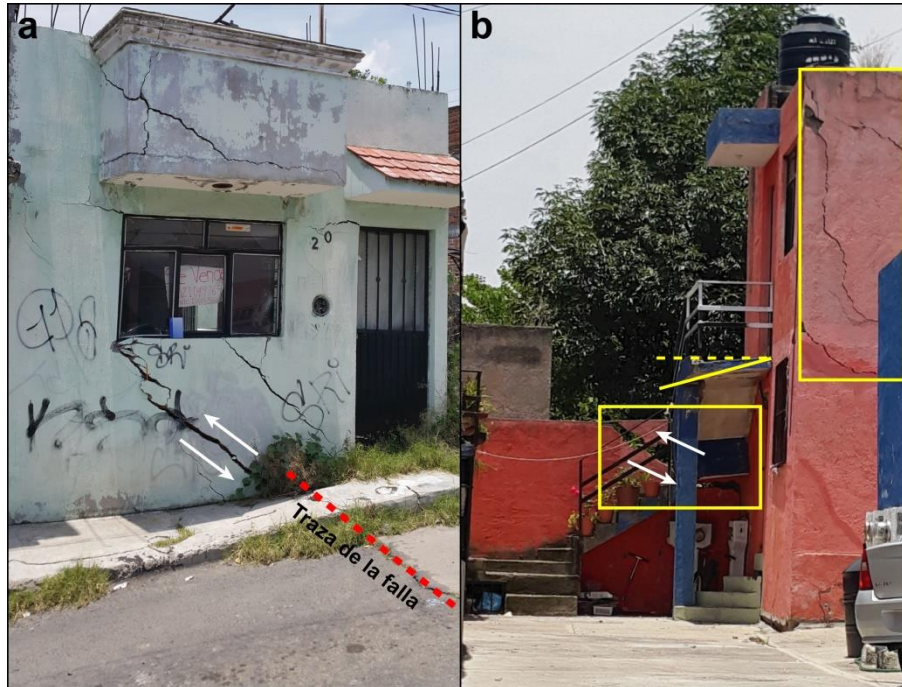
Efectos de la falla La Colina. En la imagen a, puede observarse una vivienda abandonada con evidente fracturamiento intenso a 45°. La imagen b, muestra un edificio habitacional con fisuras en sus muros de carga y un muro de contención dividido en dos, ambos construidos sobre la traza de la falla.
